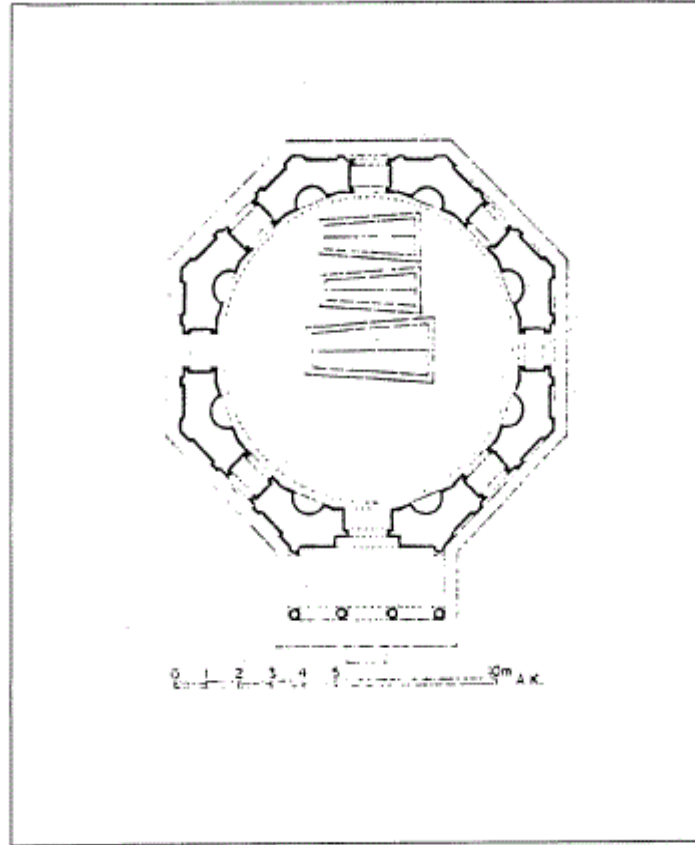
مسقط أفقي لتكية الشيخ سنان في سرايفو (عن: Pašić).
